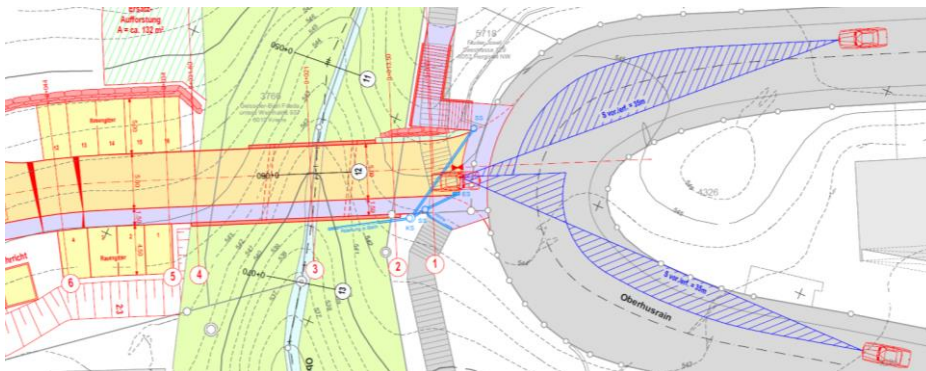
Erschliessung Weinhalde ab Oberhusrain: Vorprojekt Emch+Berger WSB AG, 05.07.2013 (Ausschnitt Situation 1:200)
